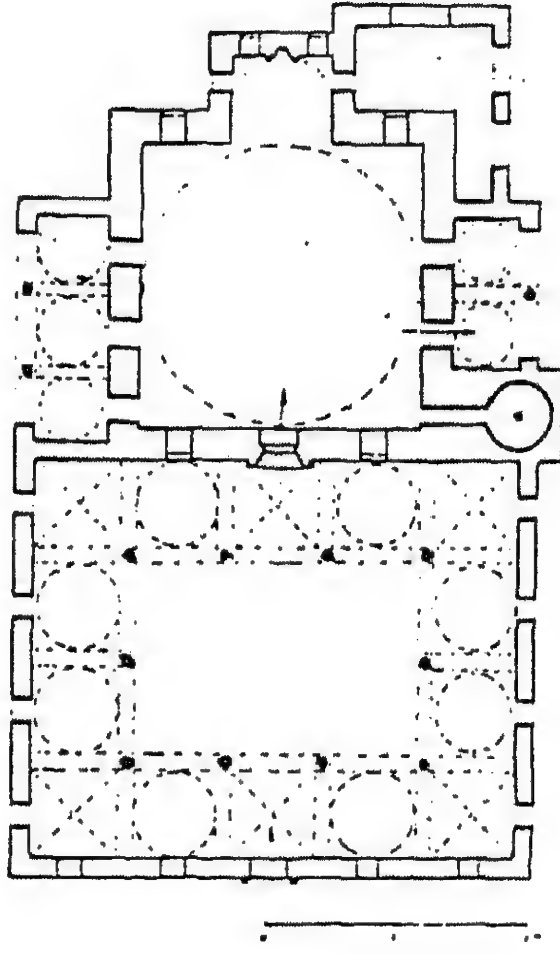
مسقط أفقي لمسجد لاله لي في استانبول (عن : جودوين) .
